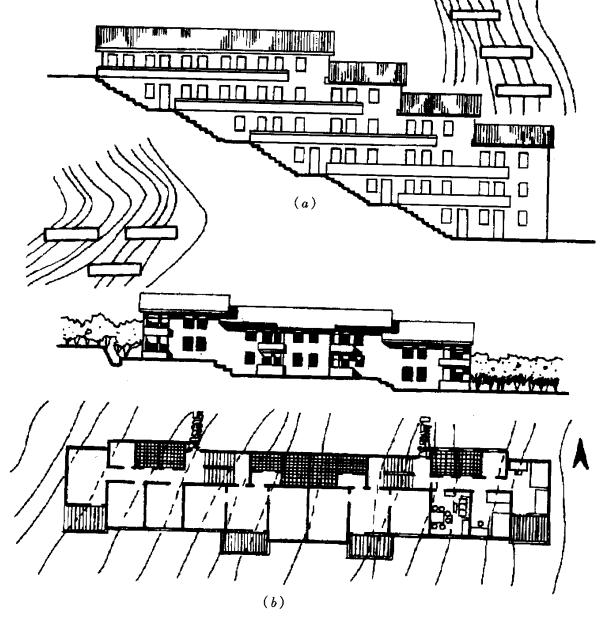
建筑物垂直或斜交于等高线的布置 (a) 垂直于等高线布置示意; (b) 斜交于等高线布置示意
